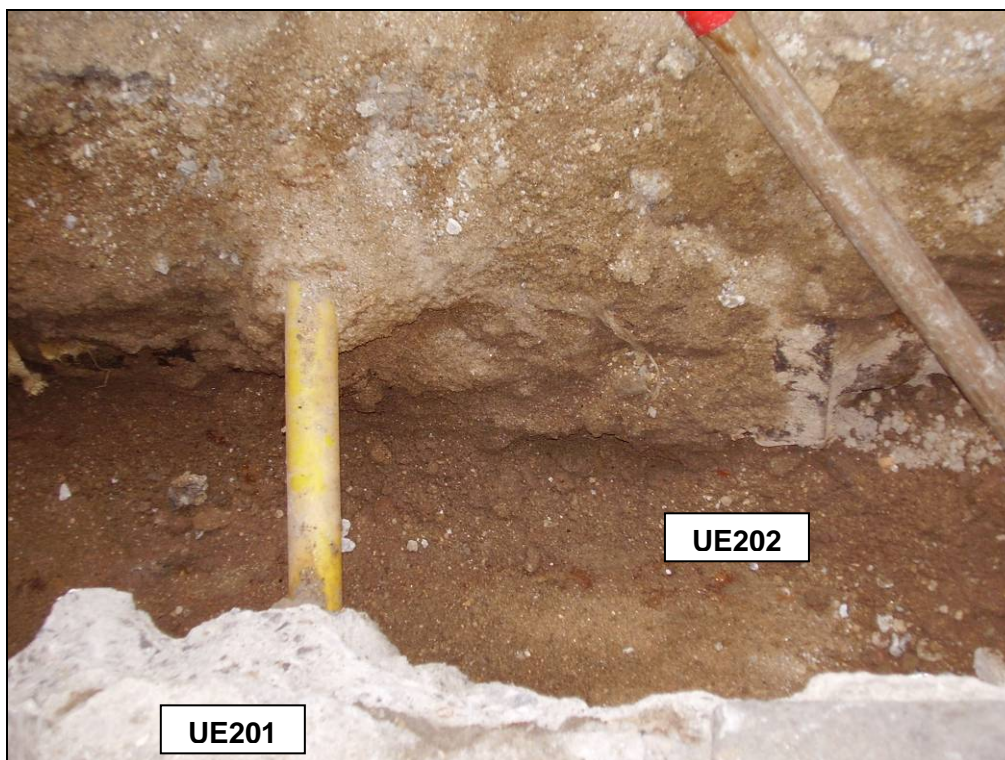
Rasa 200, treballs d'aixecament del paviment UE201
